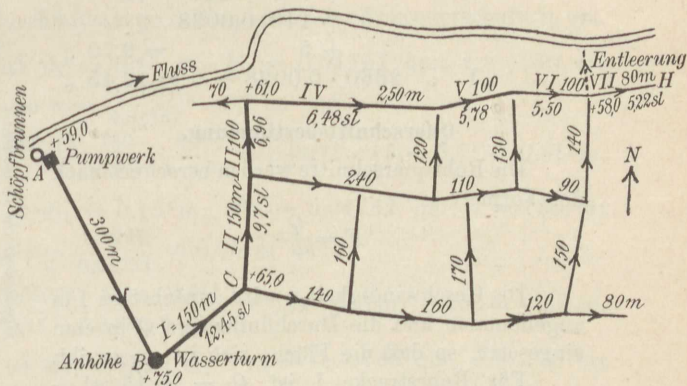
Grundwasserversorgung einer Kleinstadt. Lageplan.
